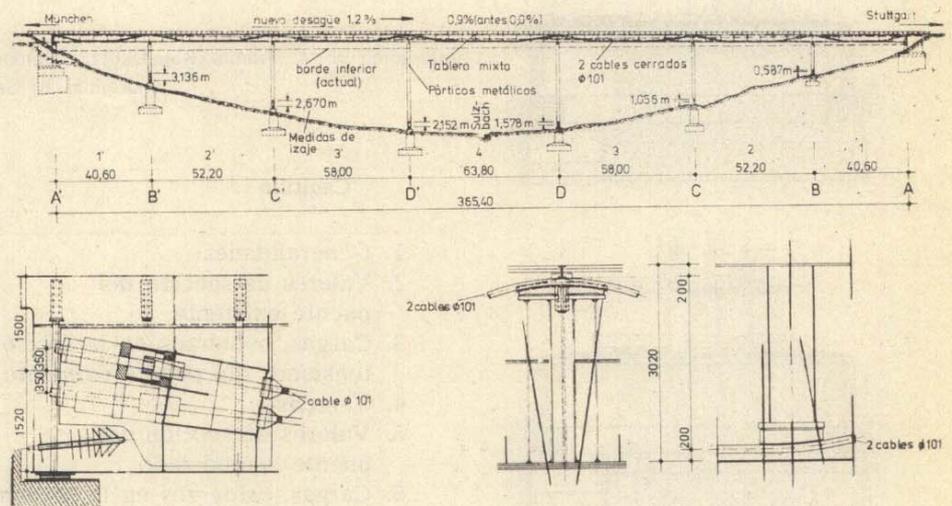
Puente sobre el Valle del Sulzbach - Vista.
